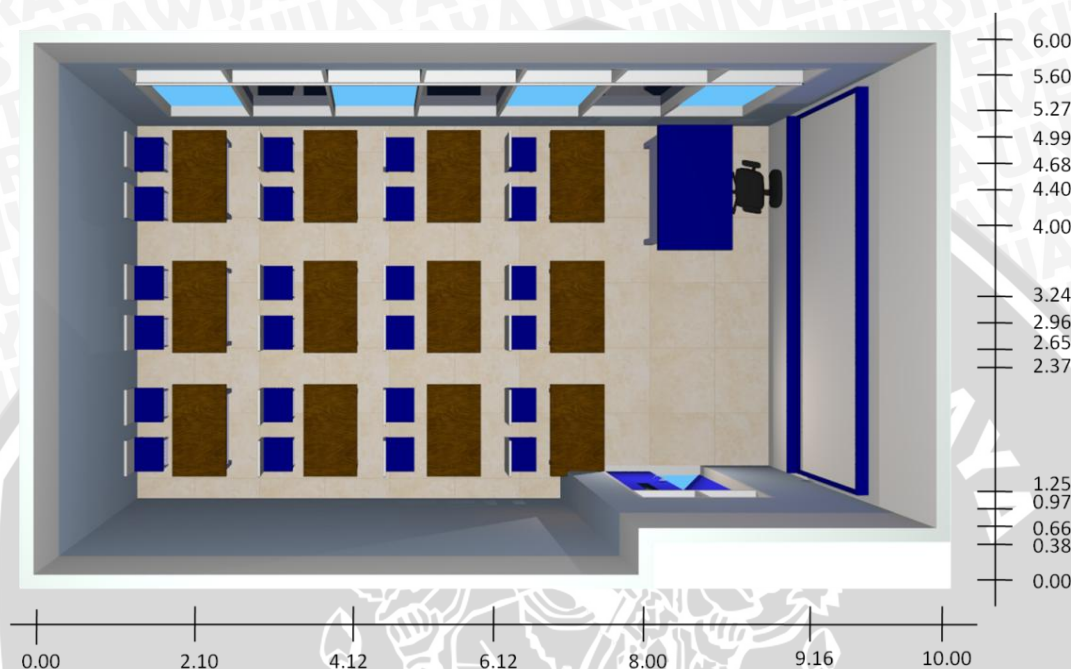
Eksterior dan Interior Ruang Kelas Teori
